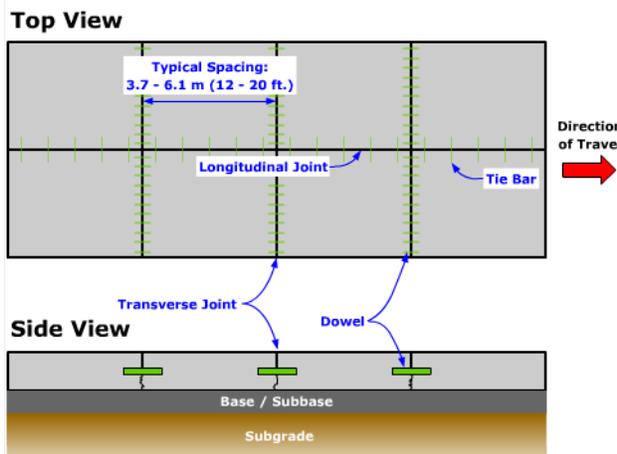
Detalle del JPCP. Fuente: Pavement Interactive (2007).
